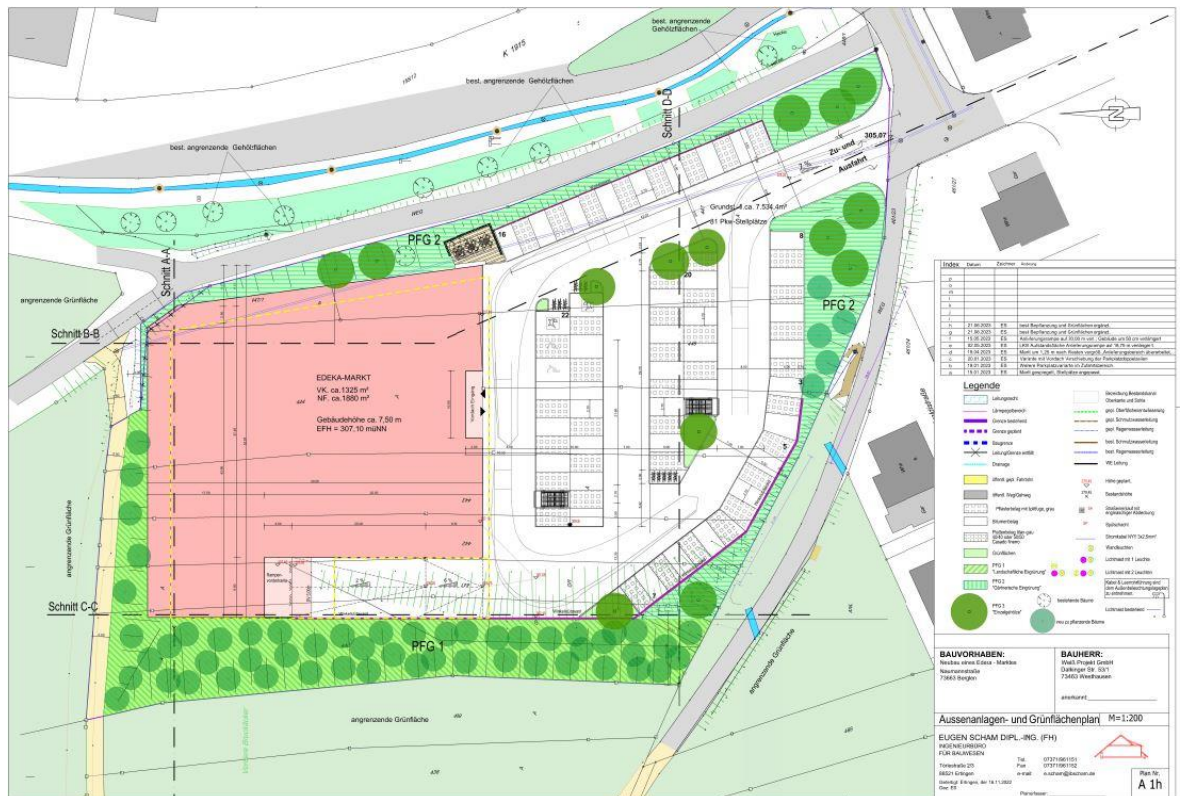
Lageplan, 21.06.2023 vorläufige Gebäudeplanung mit Freianlagen
